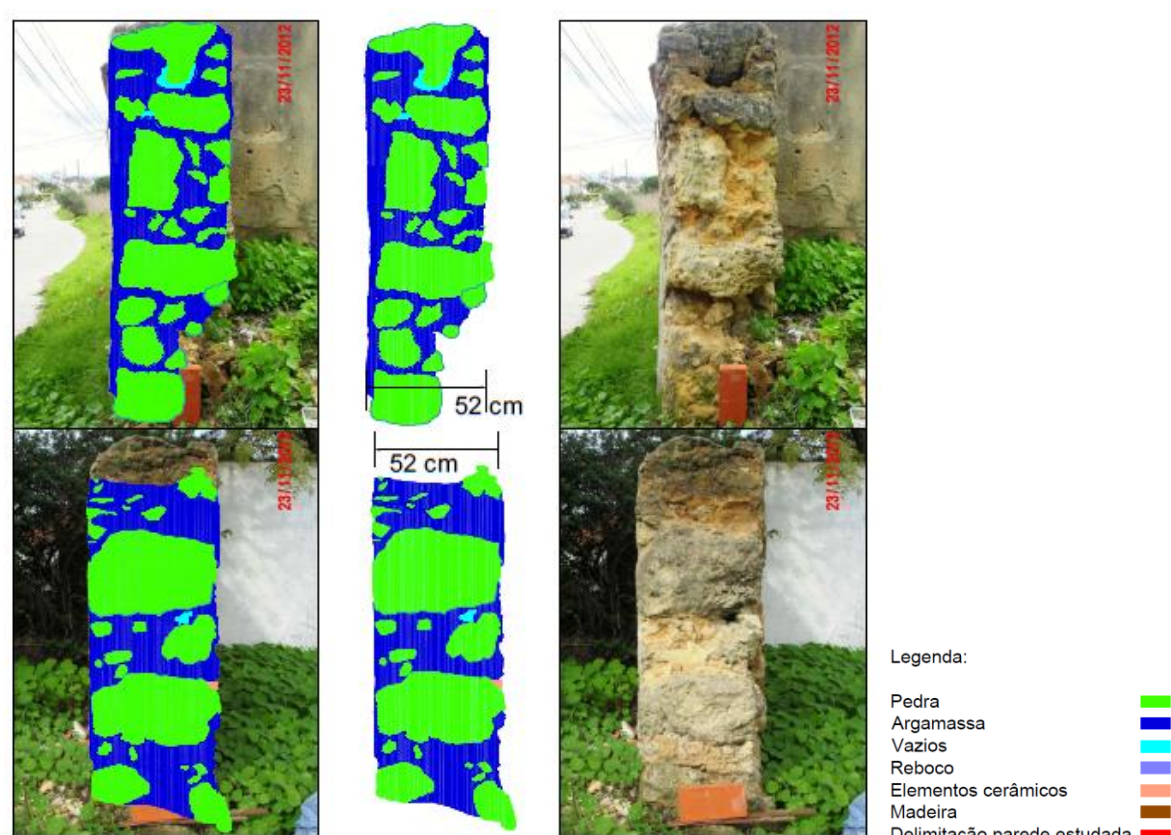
Esquemas das secções transversais da zona “Vila Nova”
